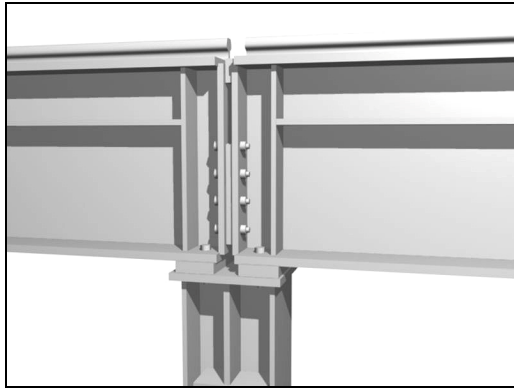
Опираение подкрановых балок через плиту на стальную колонну
